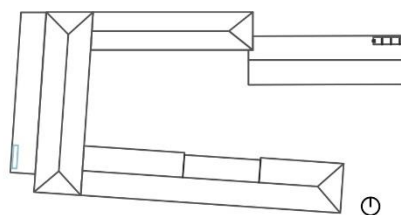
Individuazione del macroelemento in prospetto e pianta
